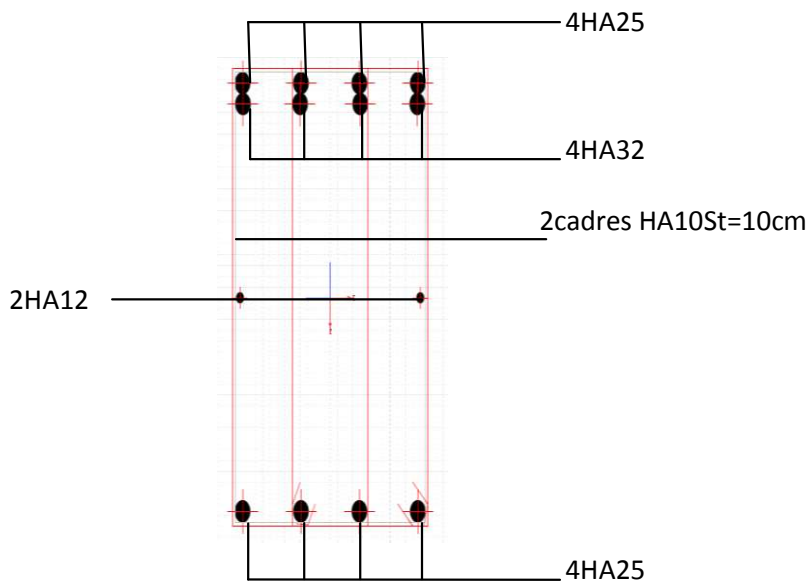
schéma du ferrailage d'une poutre en travée
